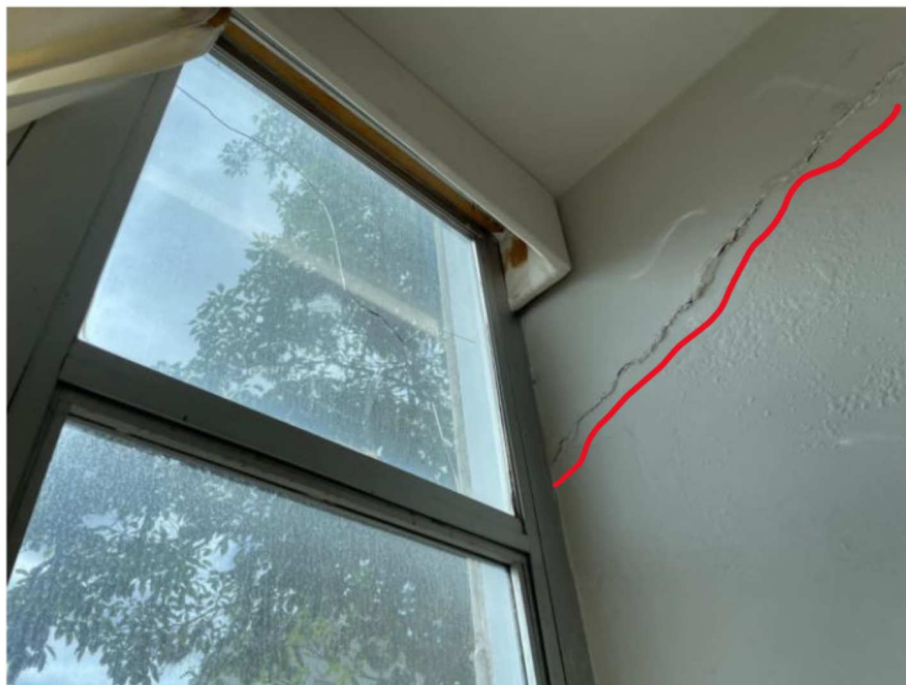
Fissura em alvenaria por recalque do piso térreo
